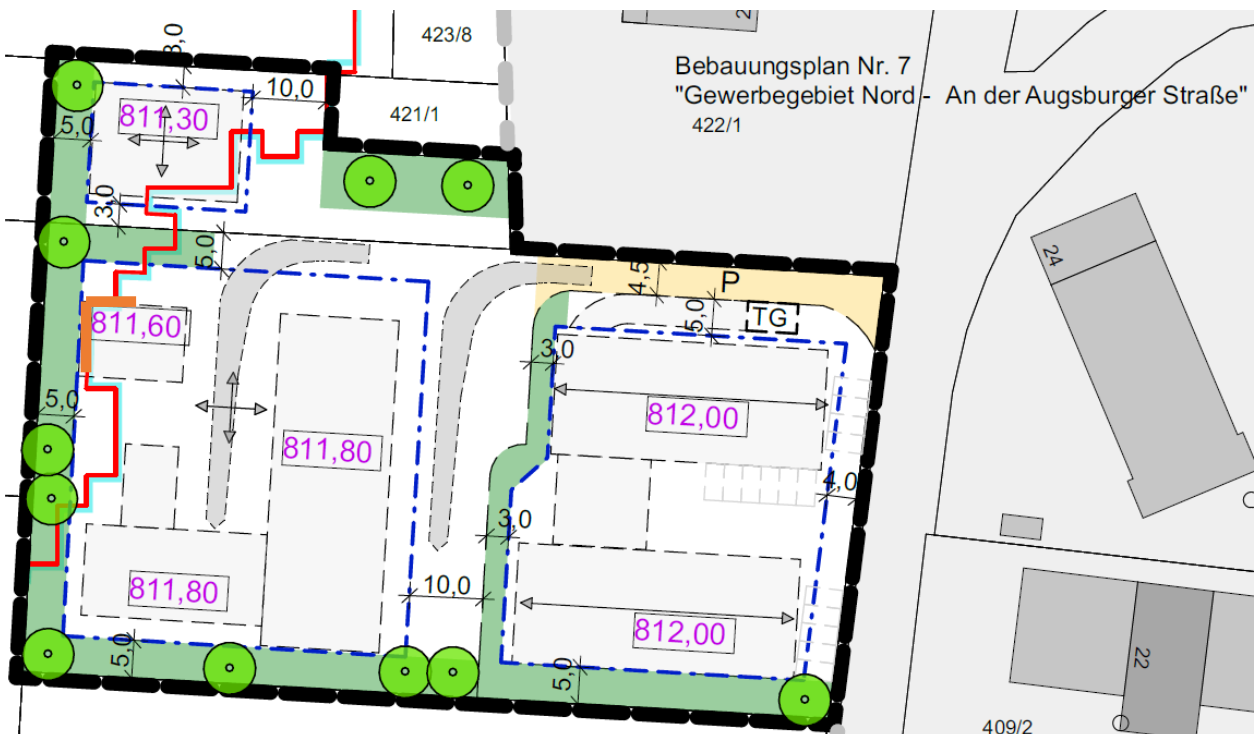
Fassaden mit Immissionswertüberschreitung (Orange)
